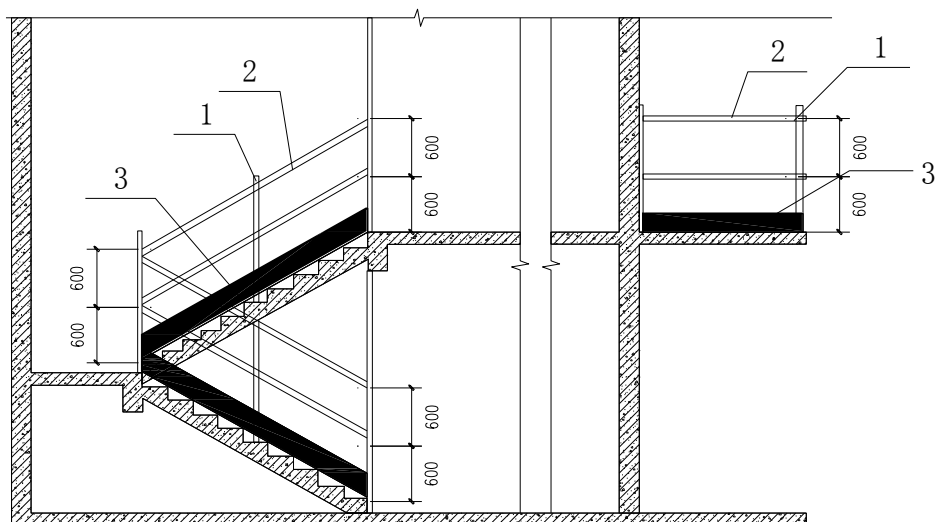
现浇施工楼梯间防护示意图（单位：mm）
